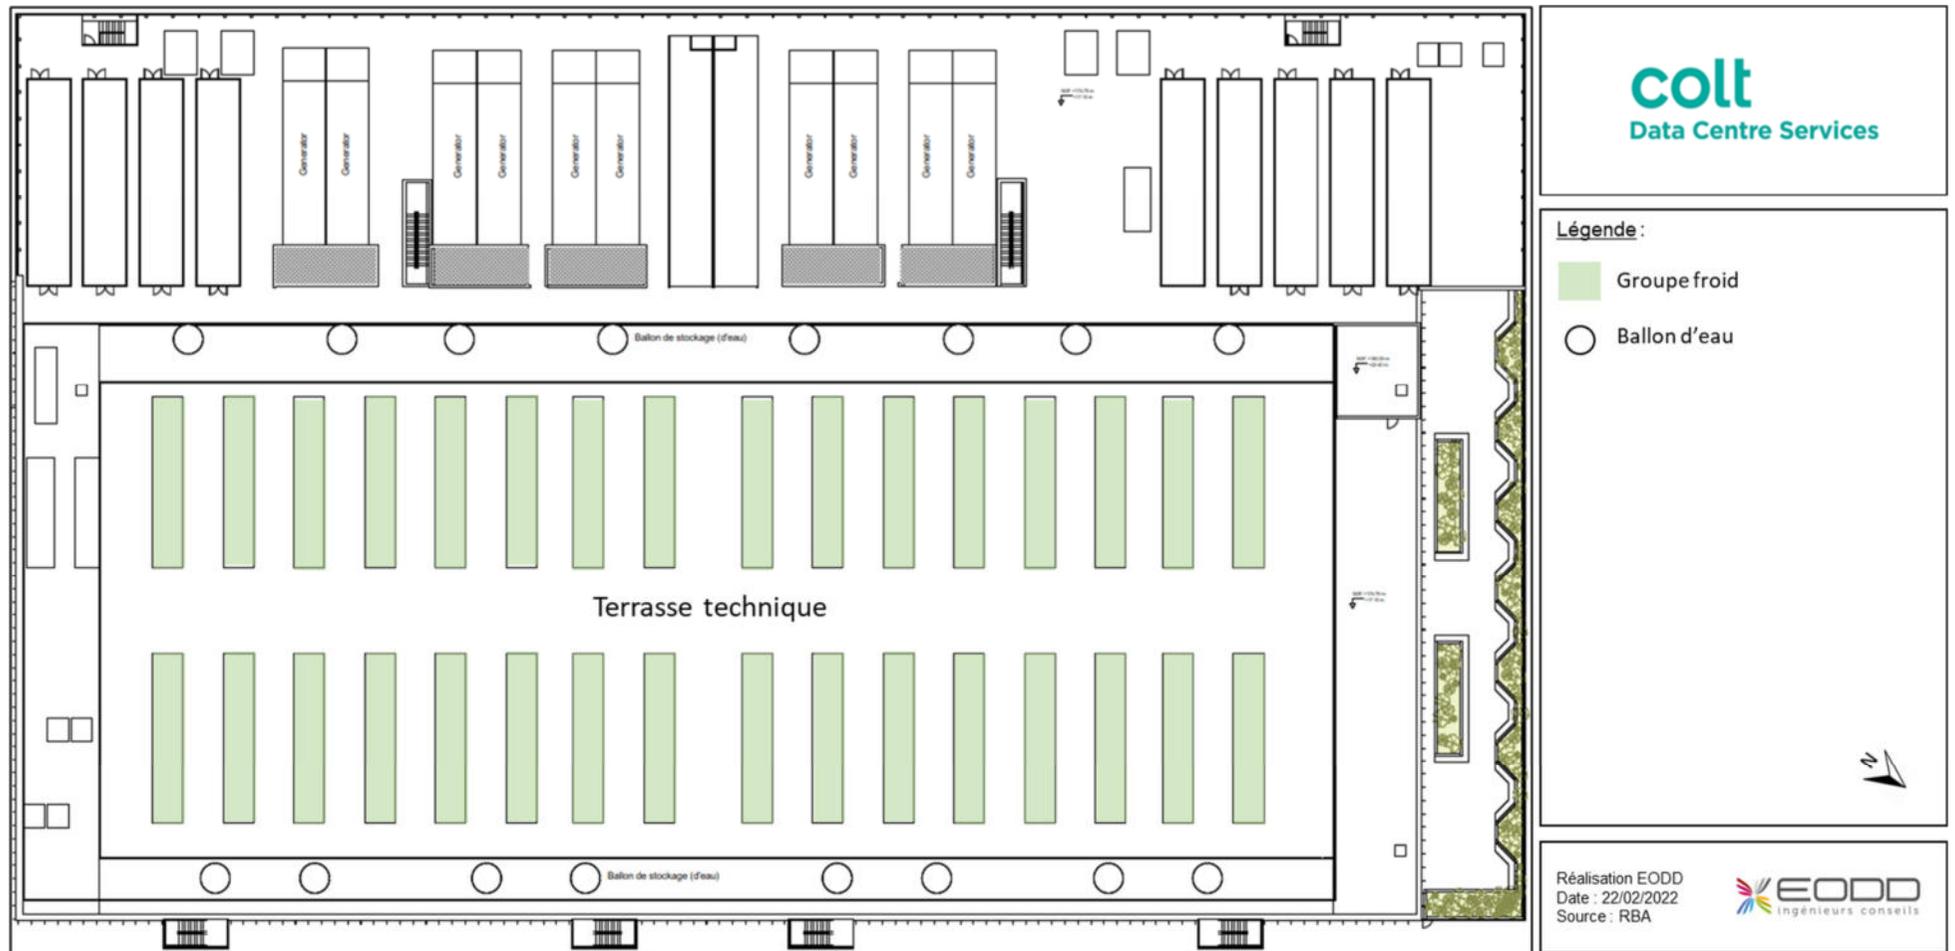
Répartition des locaux et installations – Toiture Niveau 2
